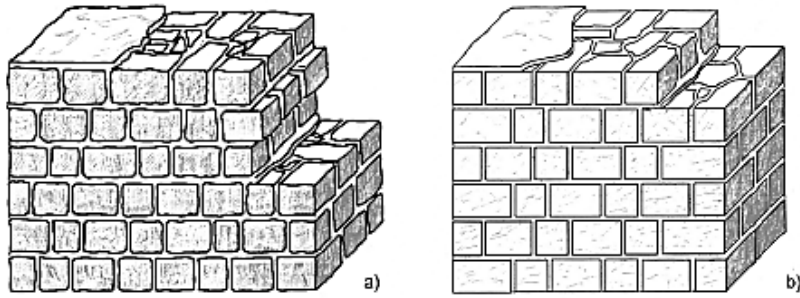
Muratura in pietrame lavorato [Menditto G., 2013]
